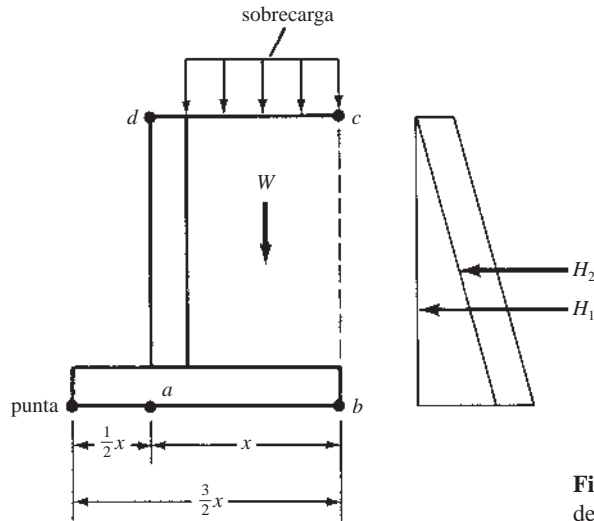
Fuerzas que actúan sobre un muro de retención tipo voladizo.
